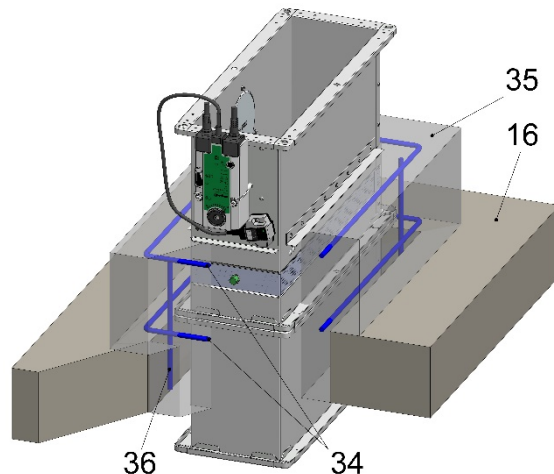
montaggio in soffitti massicci con zoccolo in calcestruzzo
